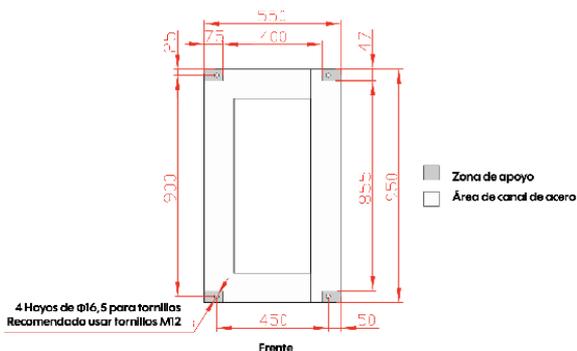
Tamaño de instalación recomendado para el canal de acero (unidad: mm)
